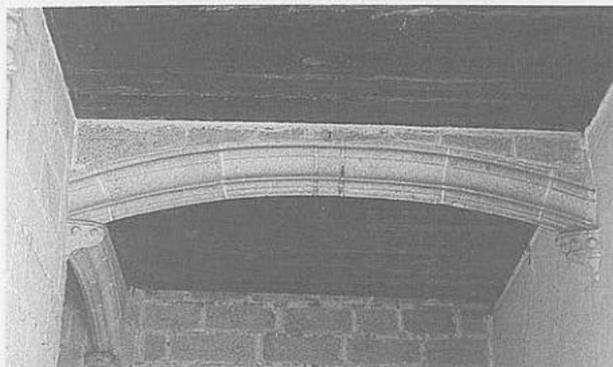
Claustro de los Reyes. Panda norte. Corredor inferior. Tirante oeste.
